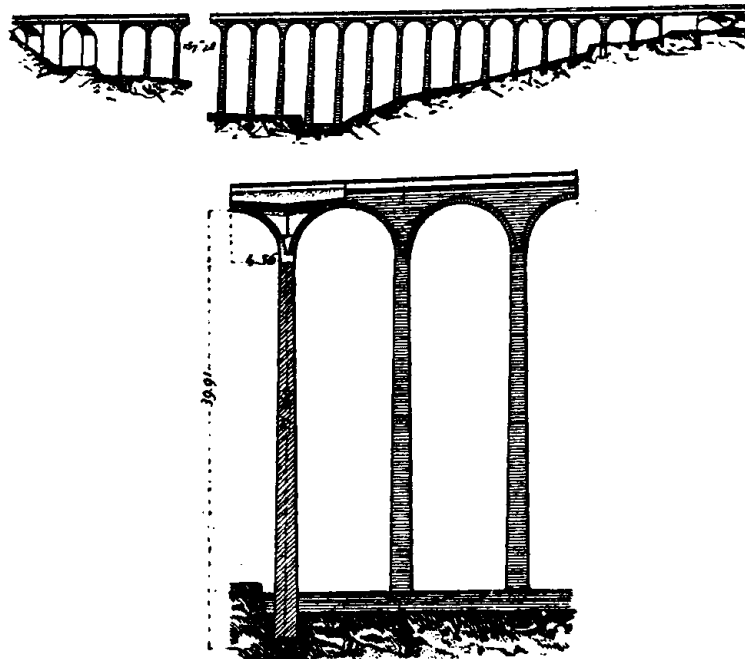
Viadotto di Lockwood (Campanella, 1928).
